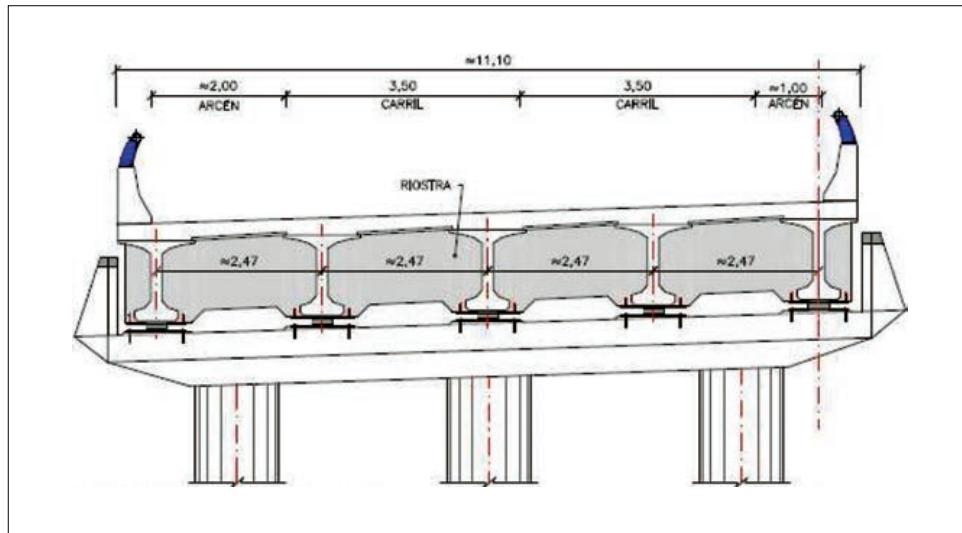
RIOSTRA ENTRE VIGAS EN APOYOS (Fuente: Actuaciones de mejora de la respuesta sísmica de puentes existentes; L. Matute; Seminarios Torroja; Madrid, 2011).
